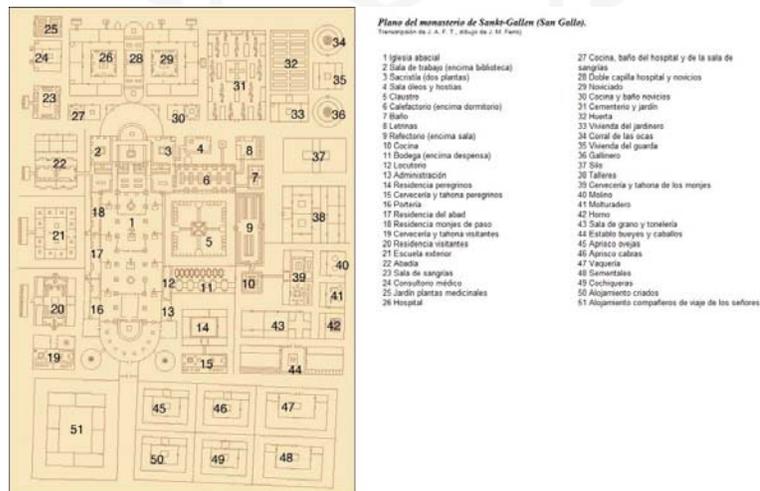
Plano ideal de la Abadía de Saint Gall, 820
